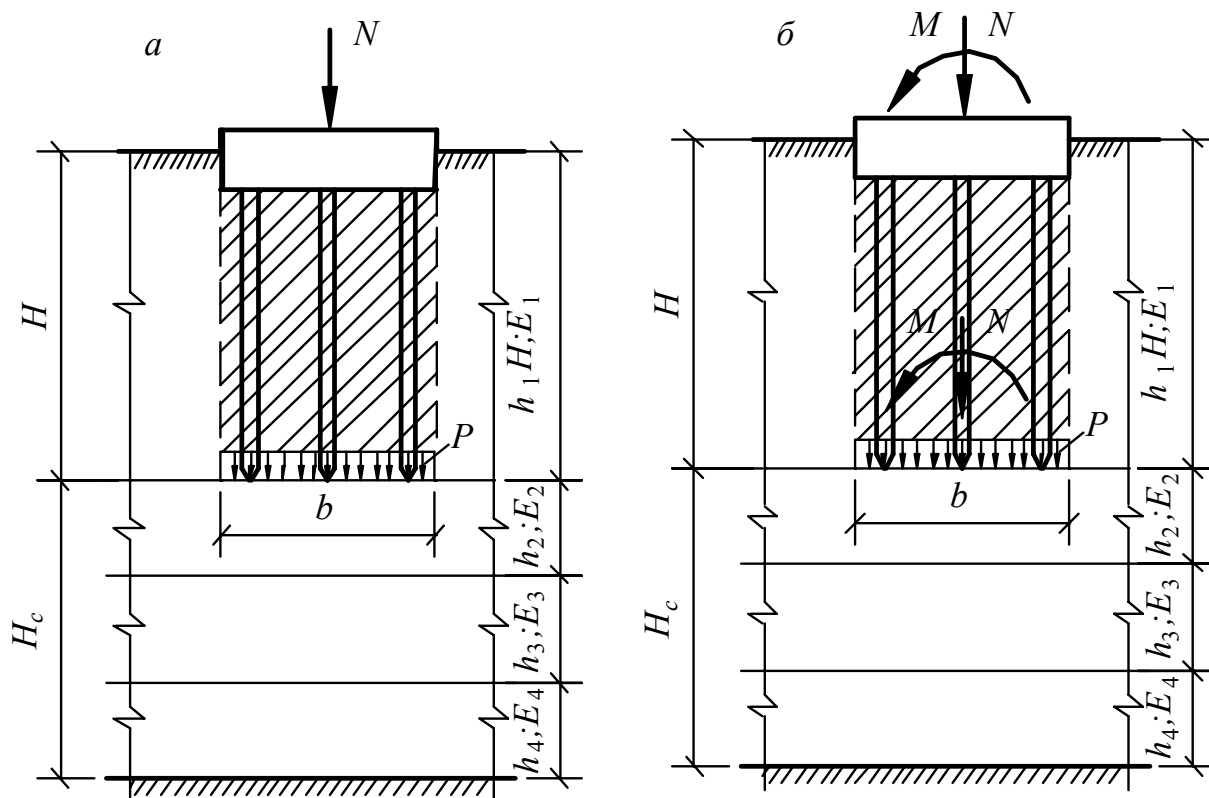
Схема расчета фундаментов из свайных полей:
